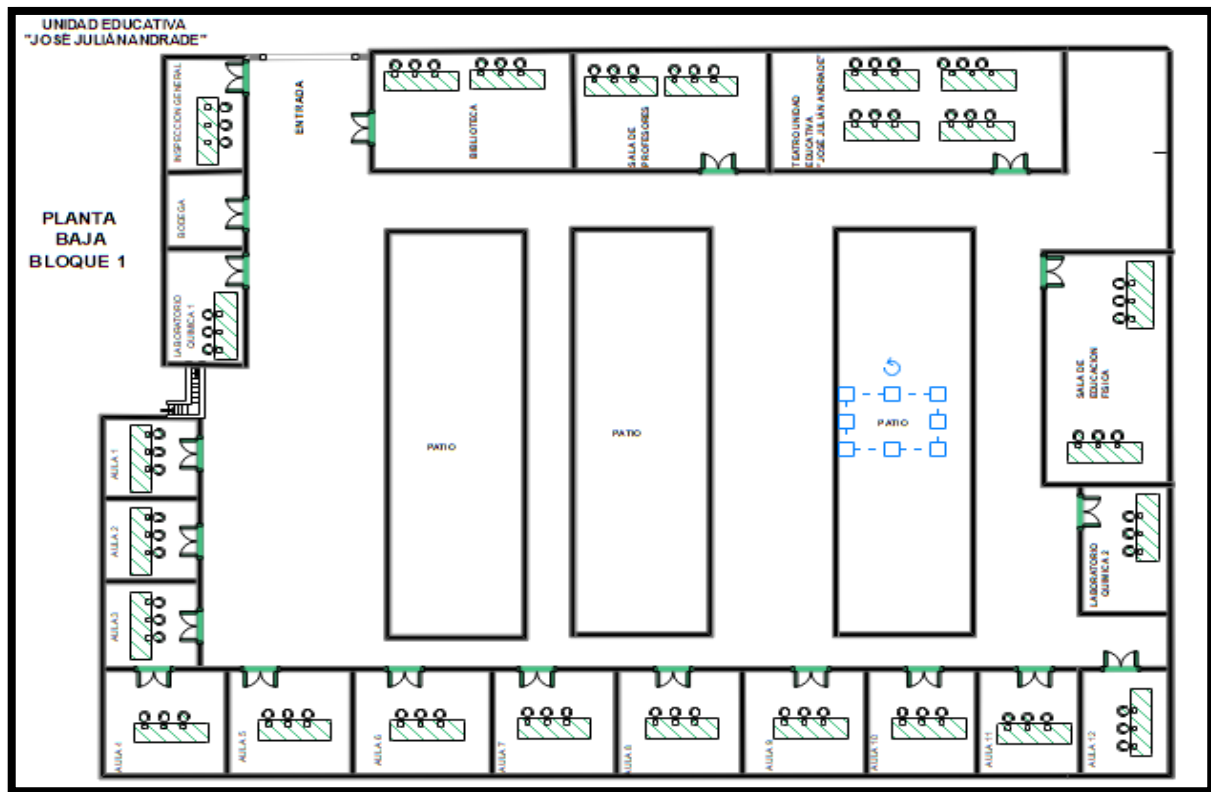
Plano de la estructura del bloque 1, planta baja de la institución.
